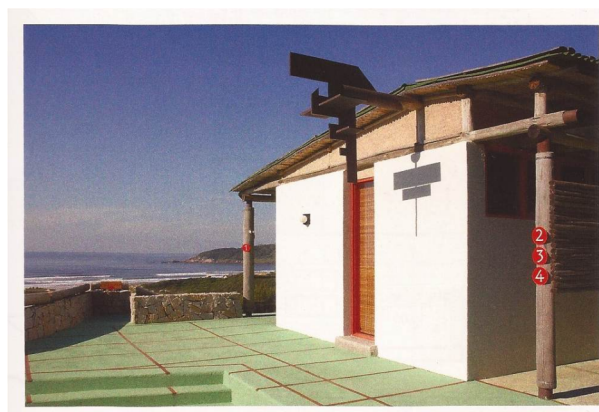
Pousada Pedra Grande - Detalhes construtivos
